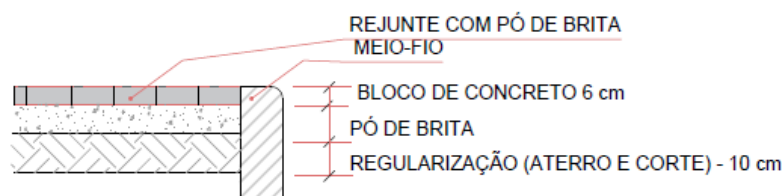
Corte Transversal – Bloco Intertravado 6 cm
